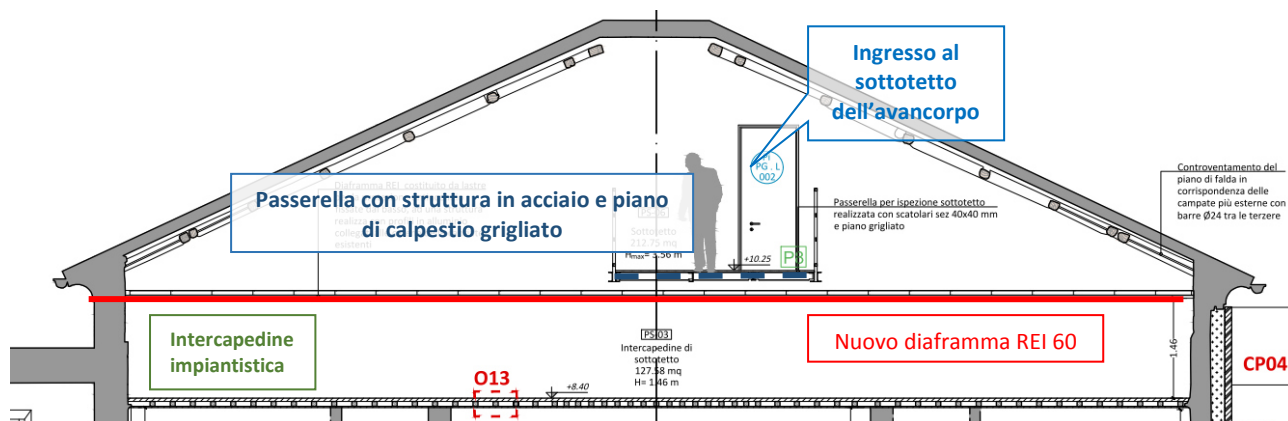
Estratto di sezione trasversale della sala verso il muro dell'avancorpo
